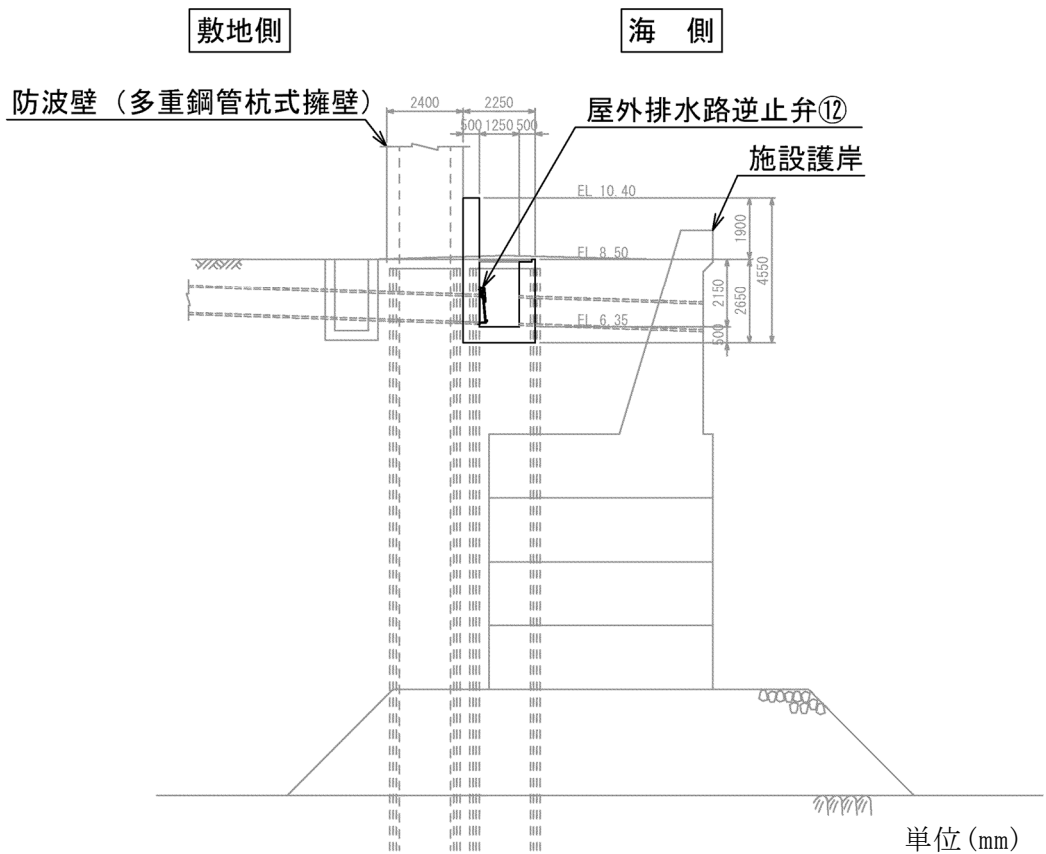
(2) 屋外排水路逆止弁 12 断面图
